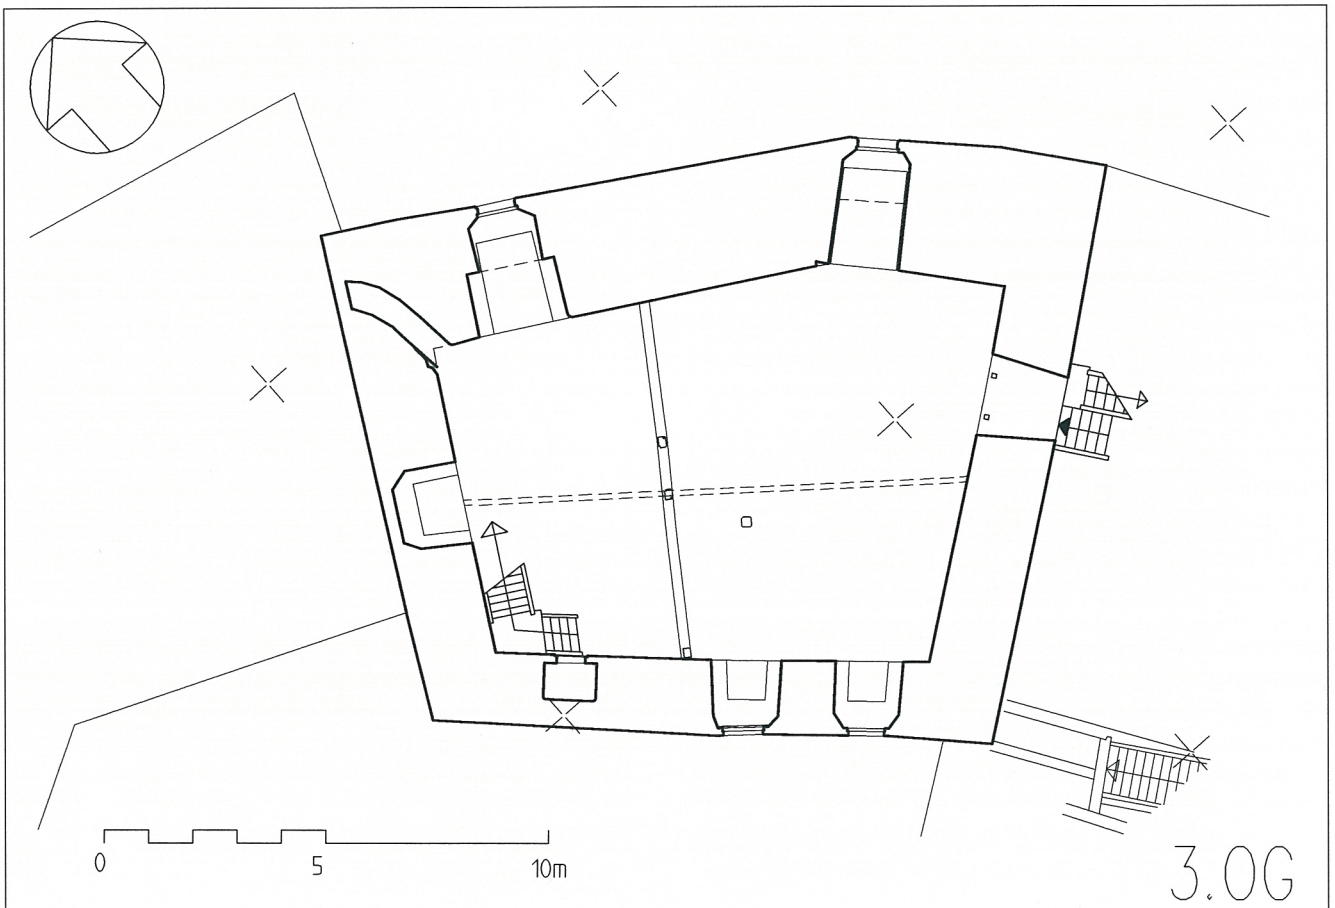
Grundriss 3. Obergeschoss „Wohnbereich“.
